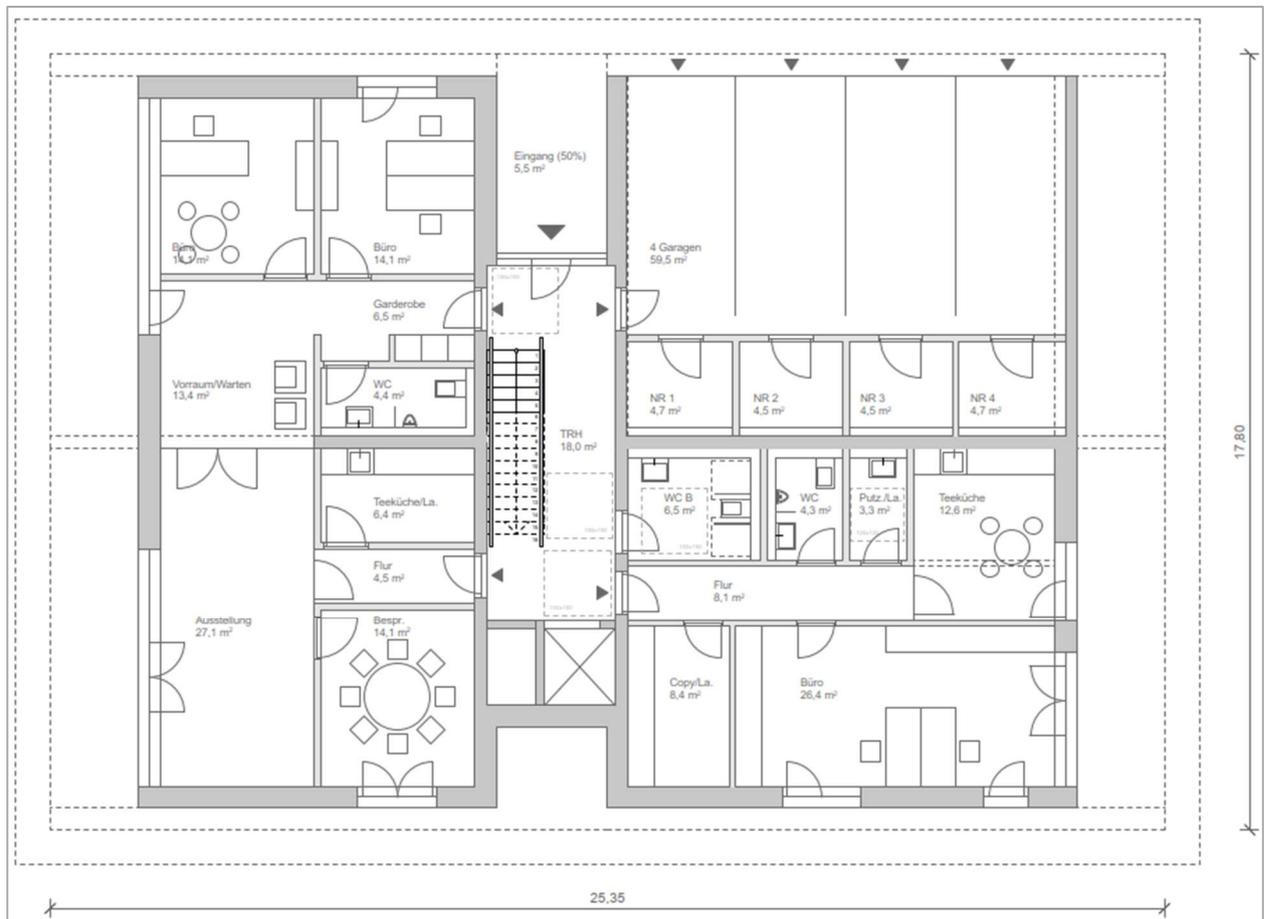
Grundriss EG (Konzept Kammerl und Kollegen, Stand 18.09.2023)
